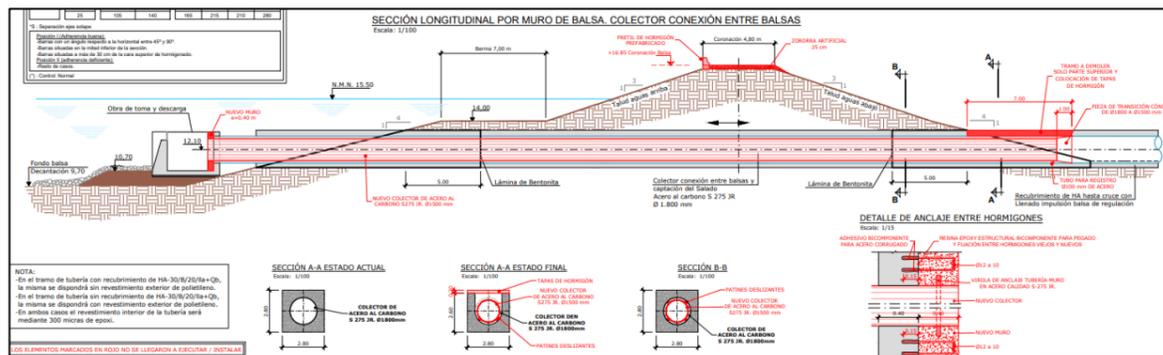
Sección longitudinal por muro de balsa colector de conexión entre balsas. Balsa Alcantarillas
